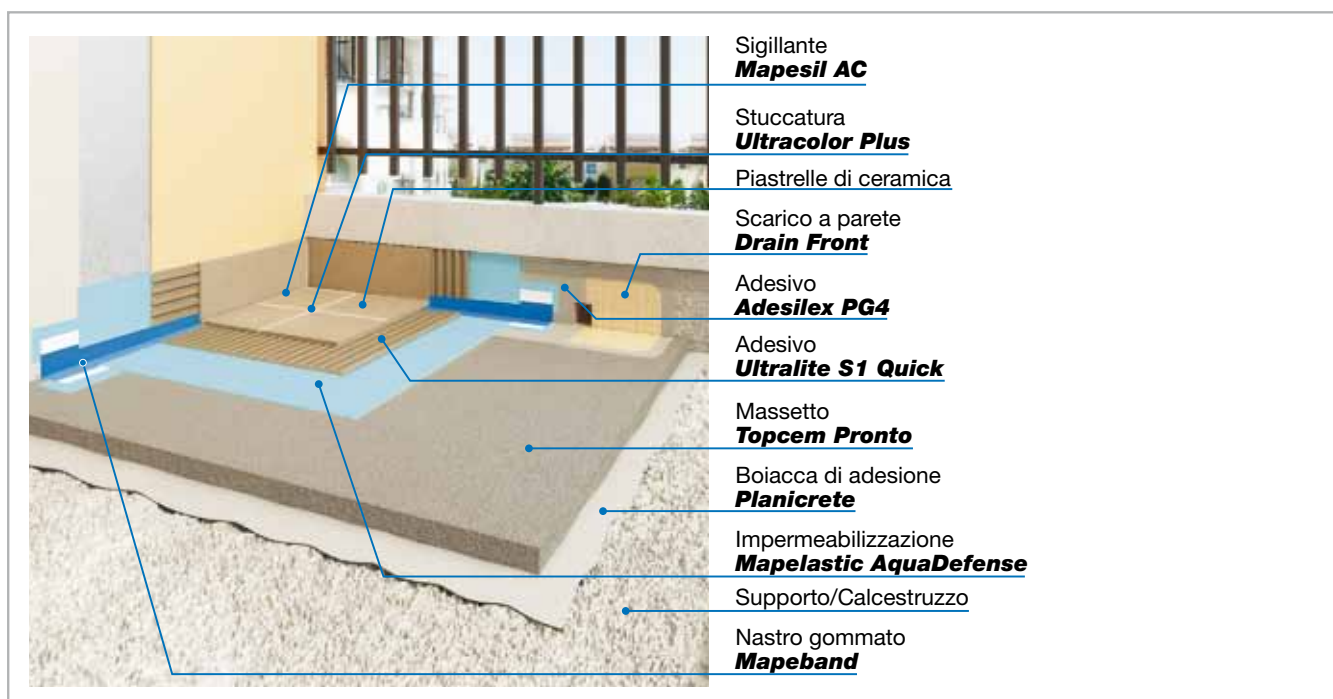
Massetto in aderenza realizzato con boiaccia di adesione a base di PLANICRETE
